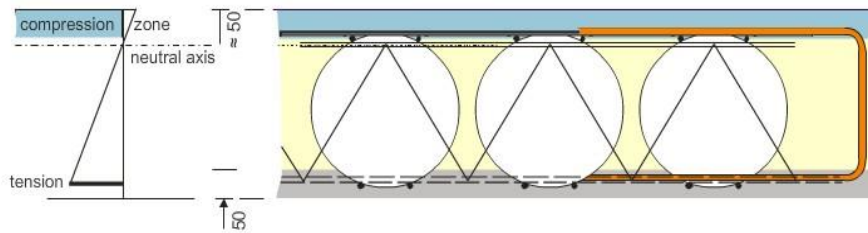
Distribución de esfuerzos en losa Bubbledeck. [6]
